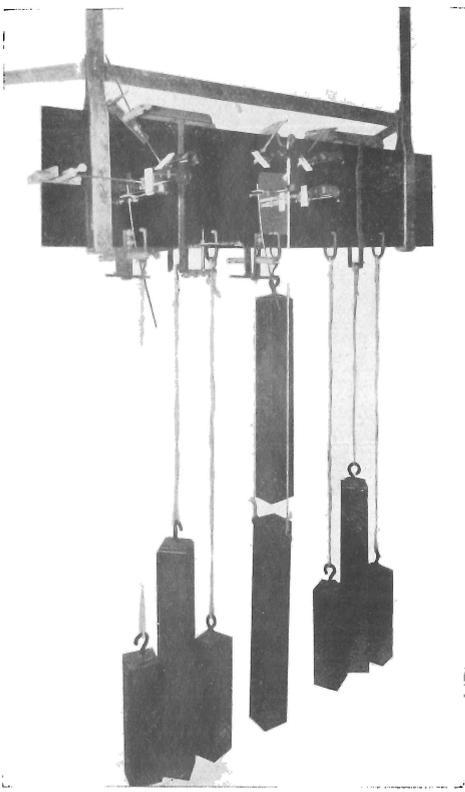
Essai sur modèle réduit d'une poutre en béton armé de 20 m. de portée à évidement central.
